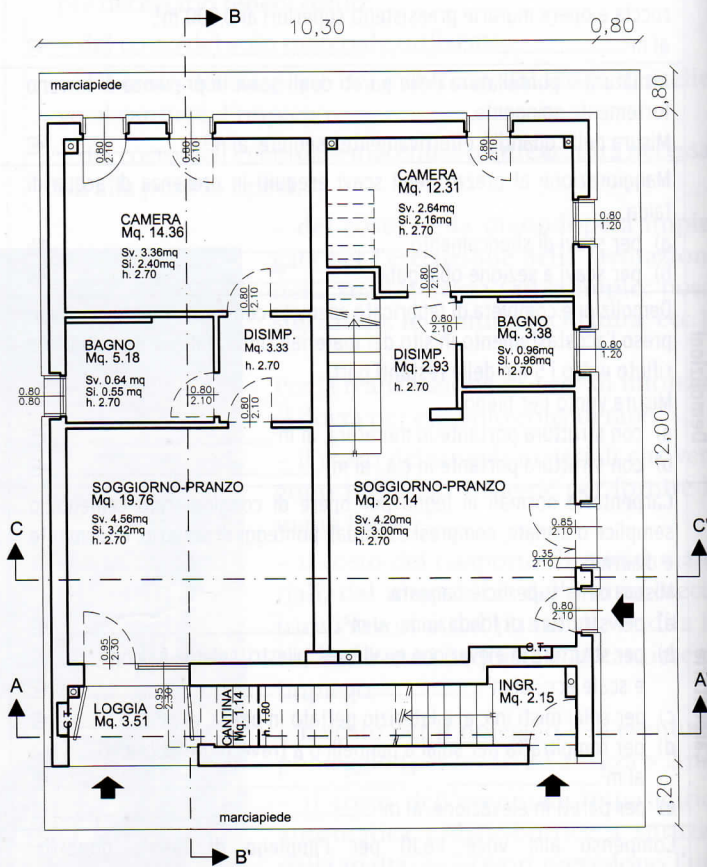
Sezioni e planimetria dell'edificio di progetto, con riferimento alle voci di computo metrico.
